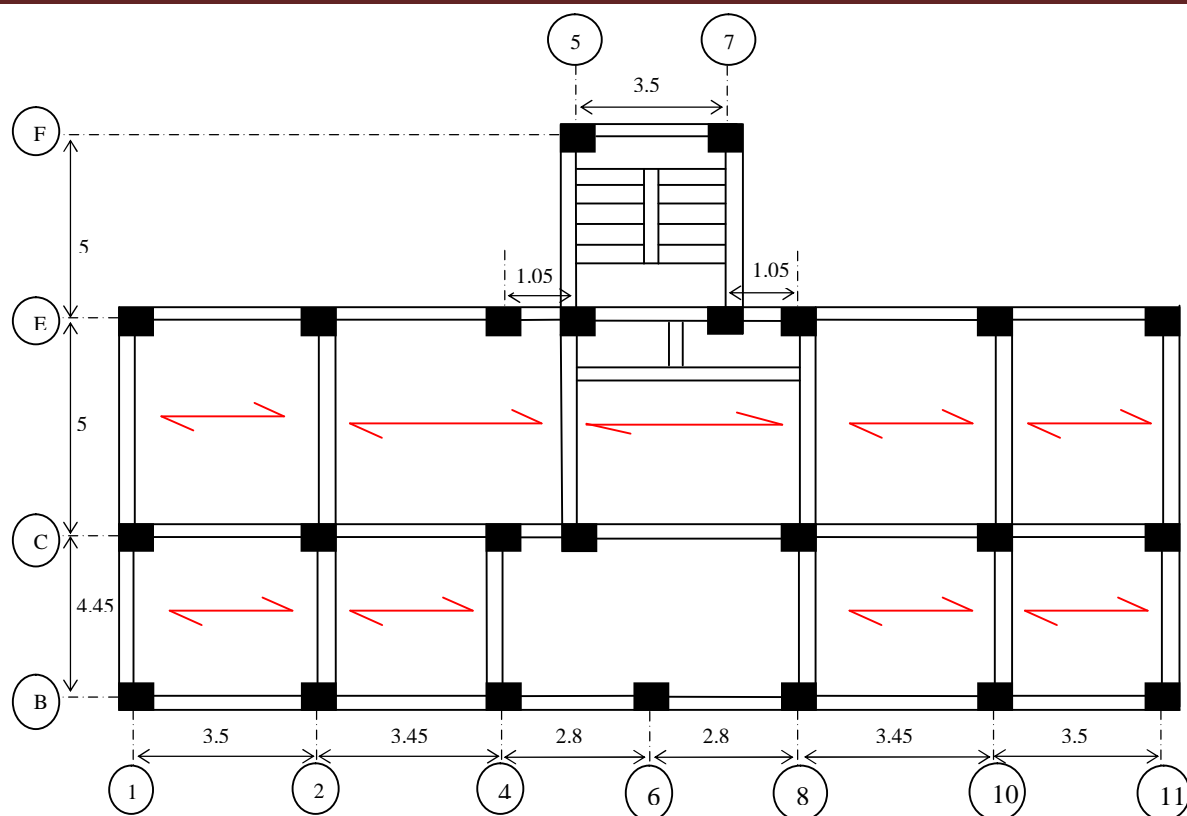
Sens de disposition des poutrelles de 5^{eme} étage.
